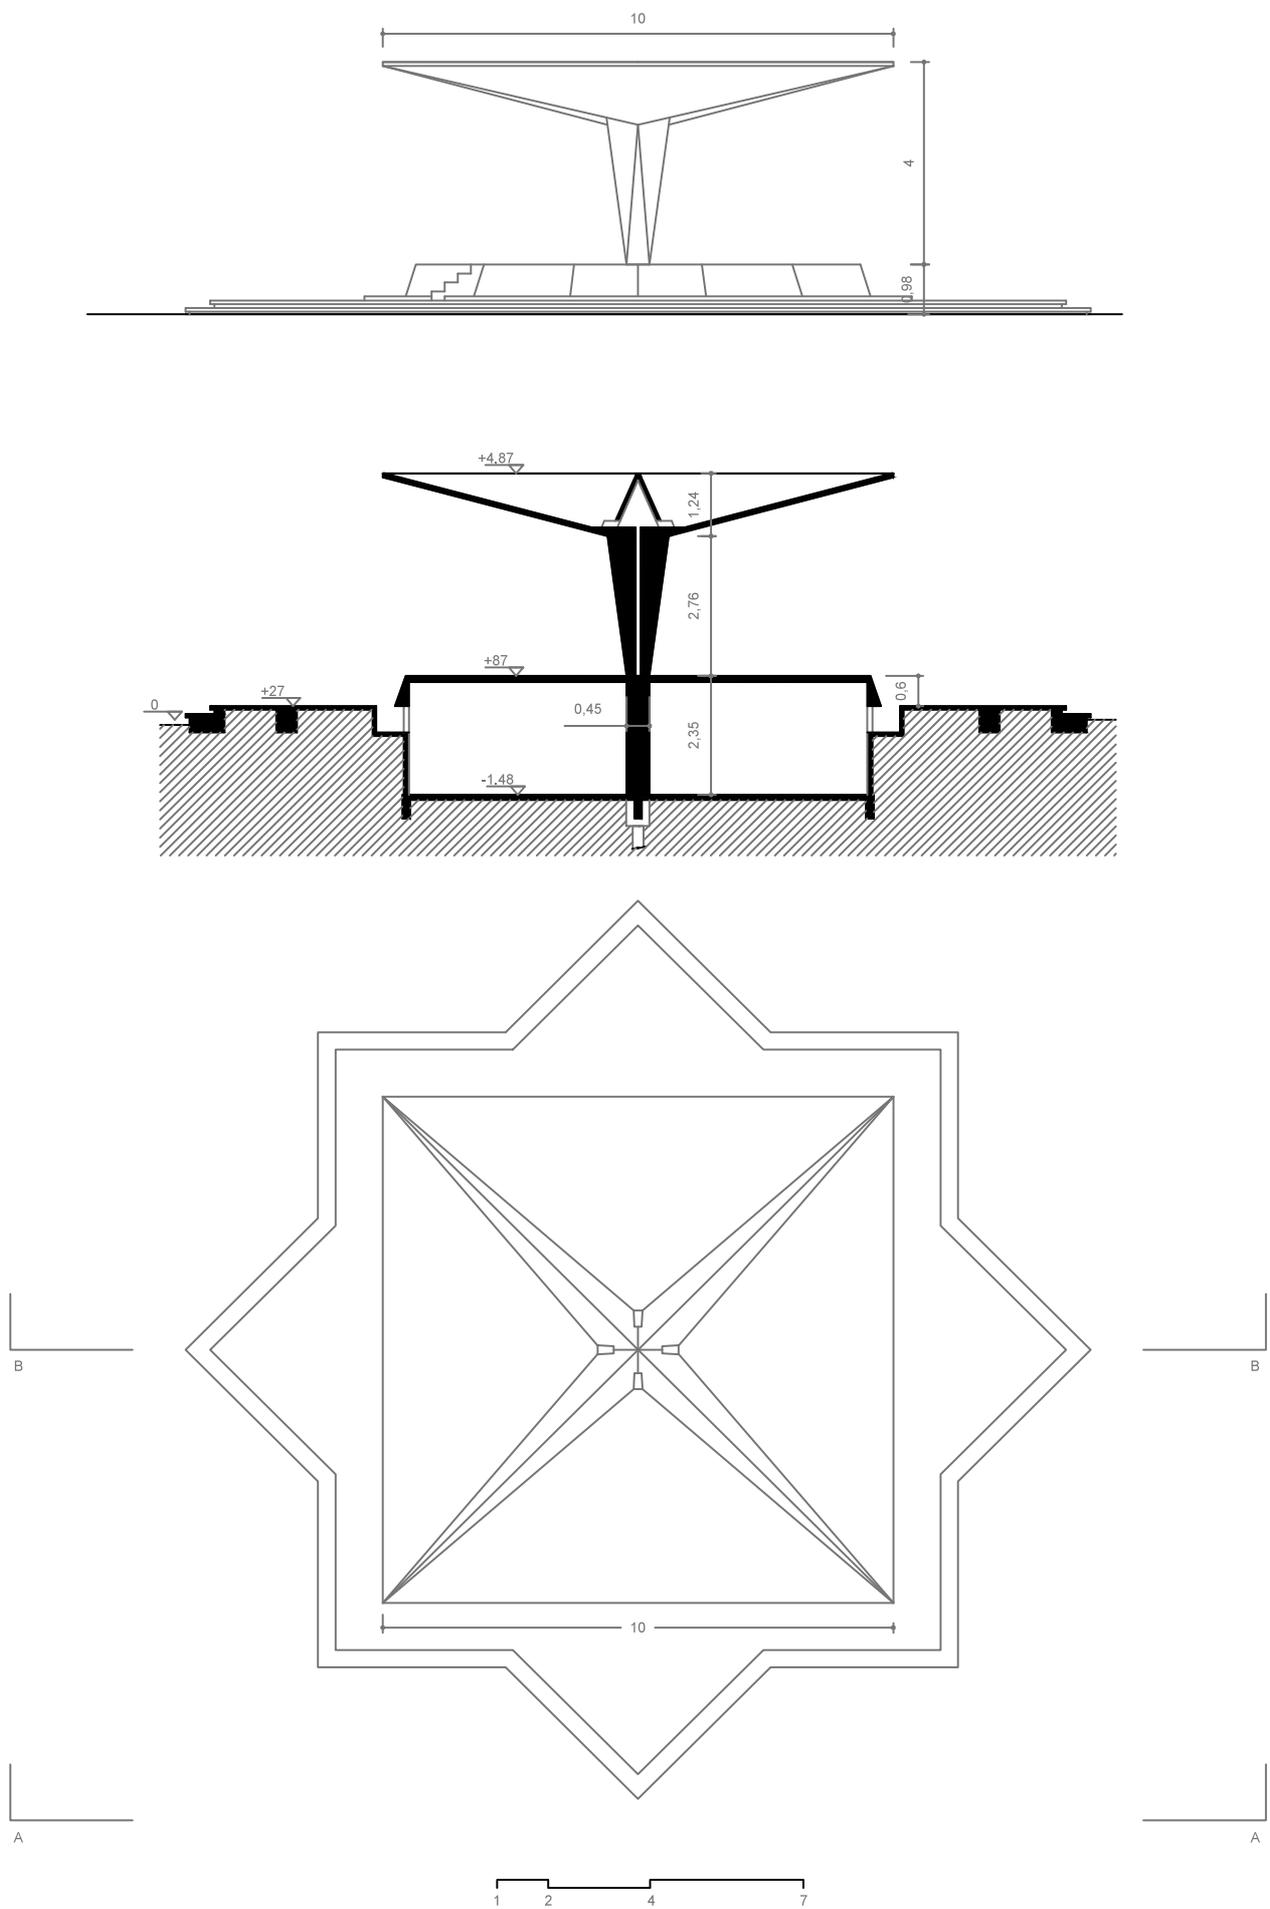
Planta de cobertura, corte transversal e elevação do Corredo.
